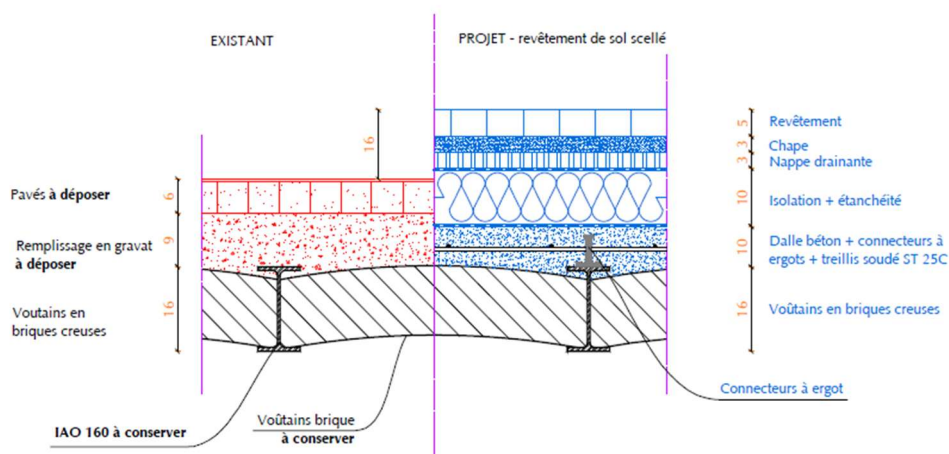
Schéma de principe du renforcement structurel et des modifications de la dalle de la cour.
